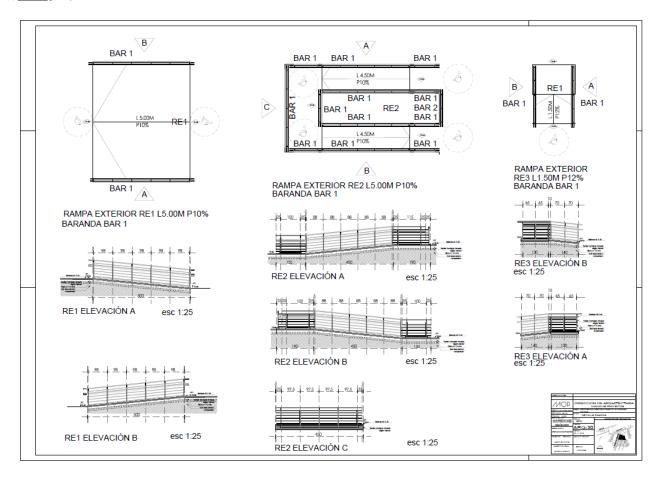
Lámina detalle de rampas/ Guixe Arquitectos Spa.
